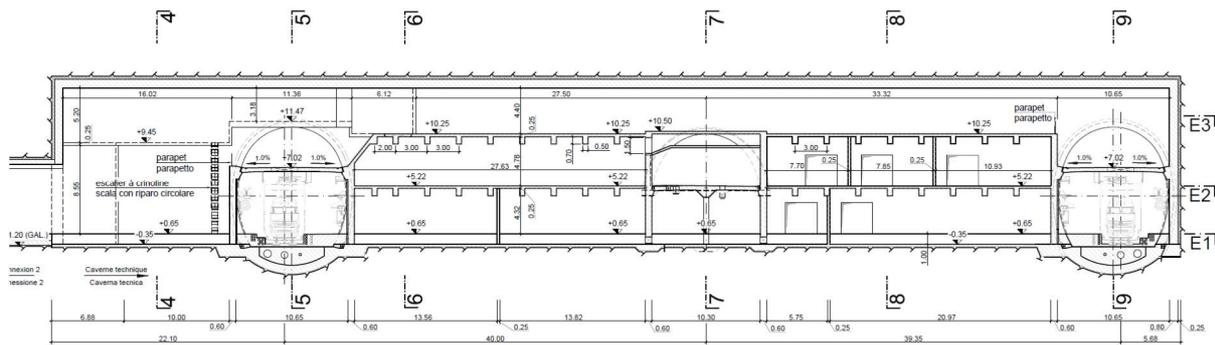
Caverna tecnica: sezione longitudinale [6]
